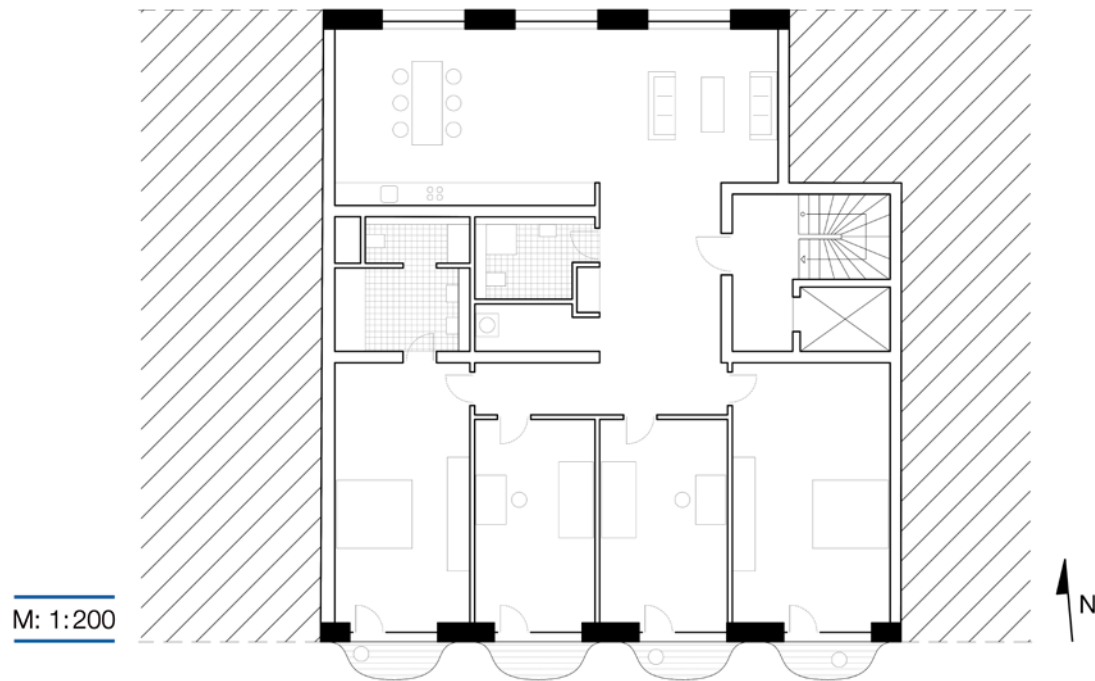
Typenentwurf »Baulücke« in Ortbetonbauweise, Grundriss Regelgeschoss
